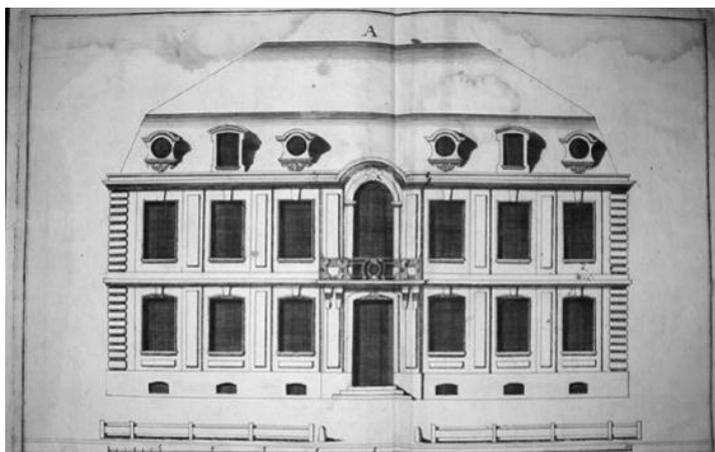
Образцовый чертеж дома для именитых, Ж.Б. Леблон, 1716 г.
